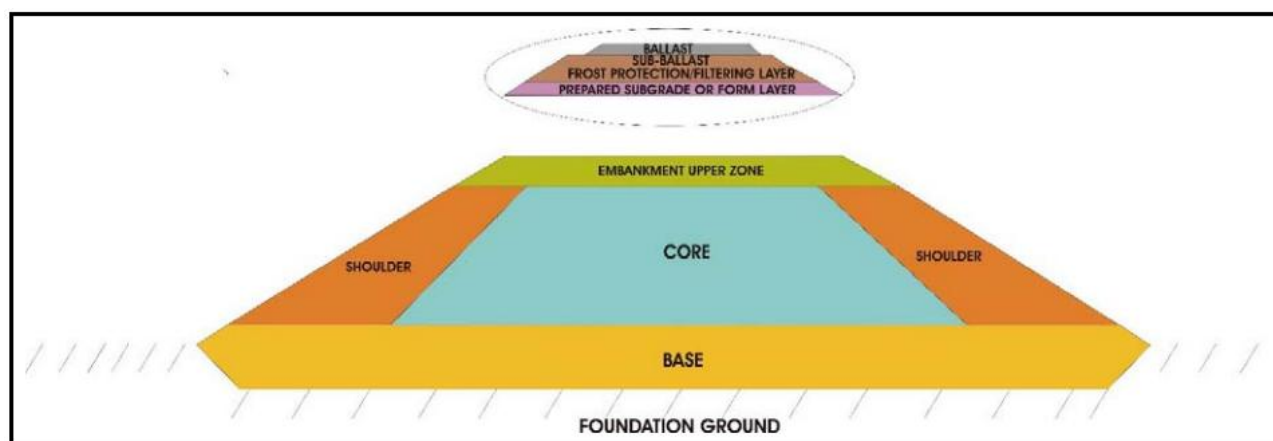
Perfil tipo de aterro zonado, de acordo com as recomendações da IRS 70719 (“ballast” – balastro; “sub-ballast” – sub-balastro; “frost protection/filtering layer” – camada de proteção contra o gelo/filtragem; “prepared subgrade or form layer” – camada de coroamento; “embankment upper zone” – parte superior do aterro (PSA); “shoulder” – espaldar; “core” – núcleo; “base” – base; “foundation ground” – solo de fundação)
